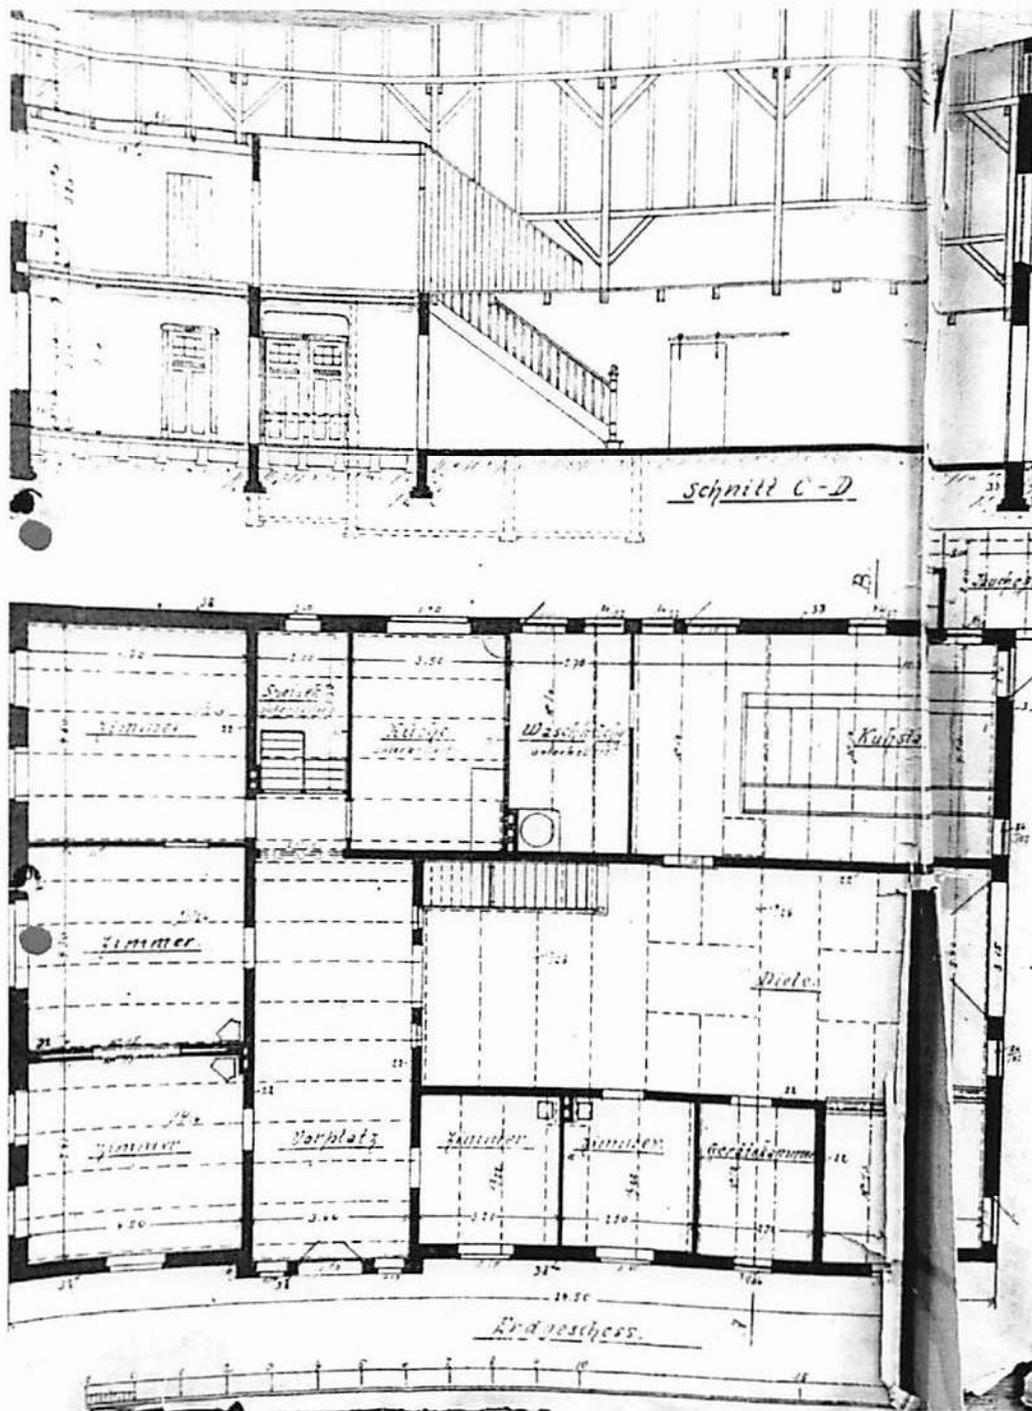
Grundrisse / Schnitte Wohngebäude
